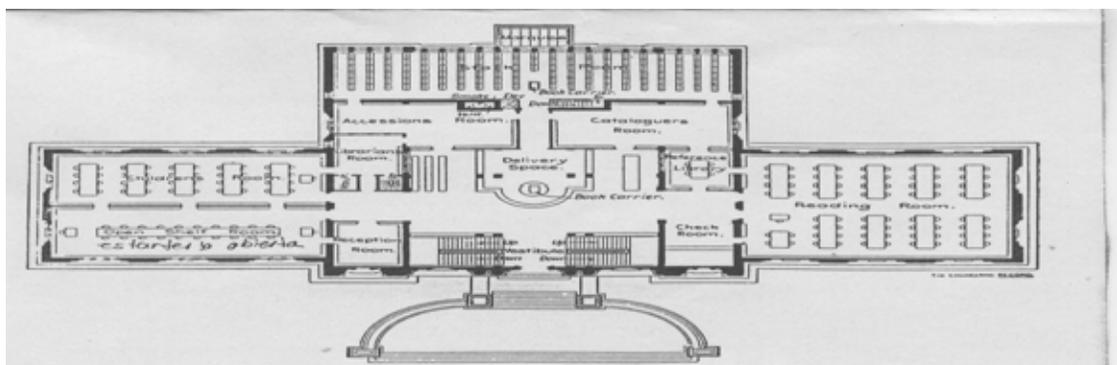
Biblioteca pública central de Washington, D. C. plano del primer piso.
